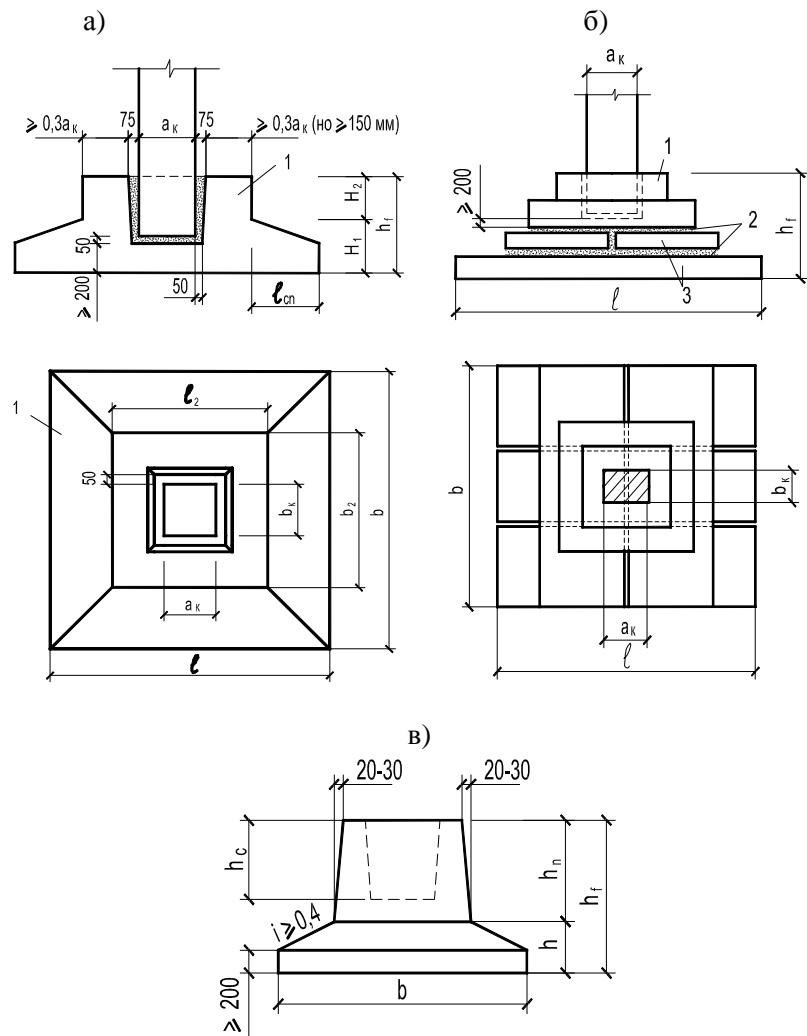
Сборные отдельные фундаменты: а, в – одноэлементный; б – составной из блоков; 1 – стакан; 2 – цементный раствор; 3 – блоки.
